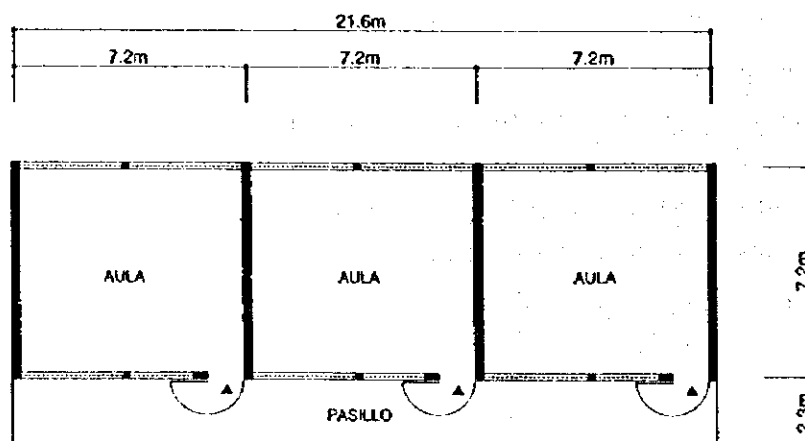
PLANTA GENERAL DEL TIPO 3 AULAS DE EDUCACION BASICA
